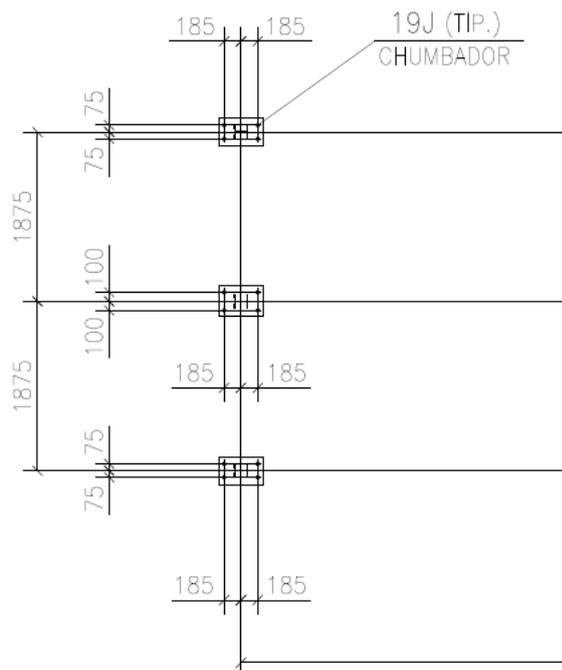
PASSARELA FIXA – CHUMBADORES DE FIXAÇÃO DAS VIGAS
